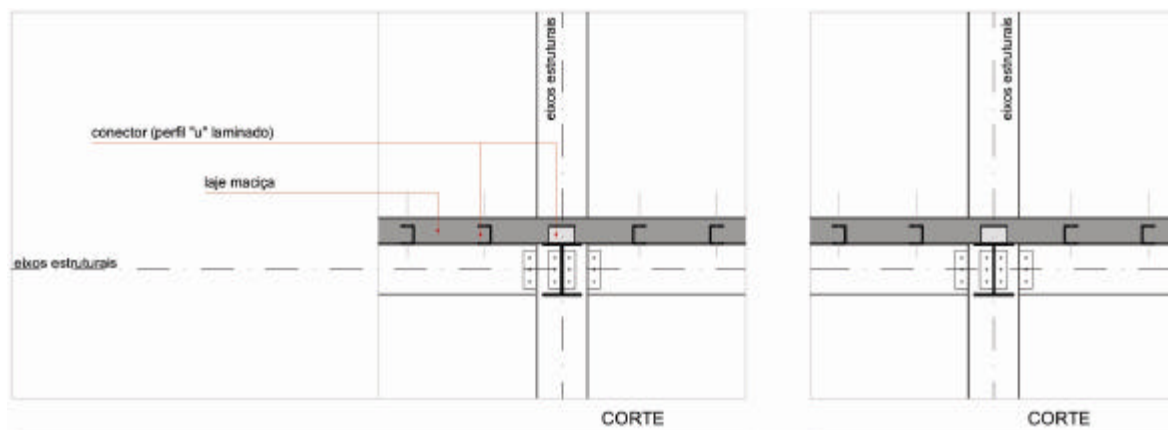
Detalhe construtivo - lajes de concreto moldadas no local.
